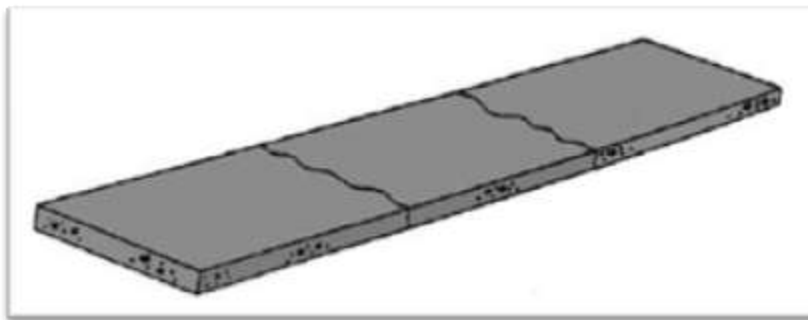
Agrietamiento inicial en un pavimento de concreto sin juntas.
